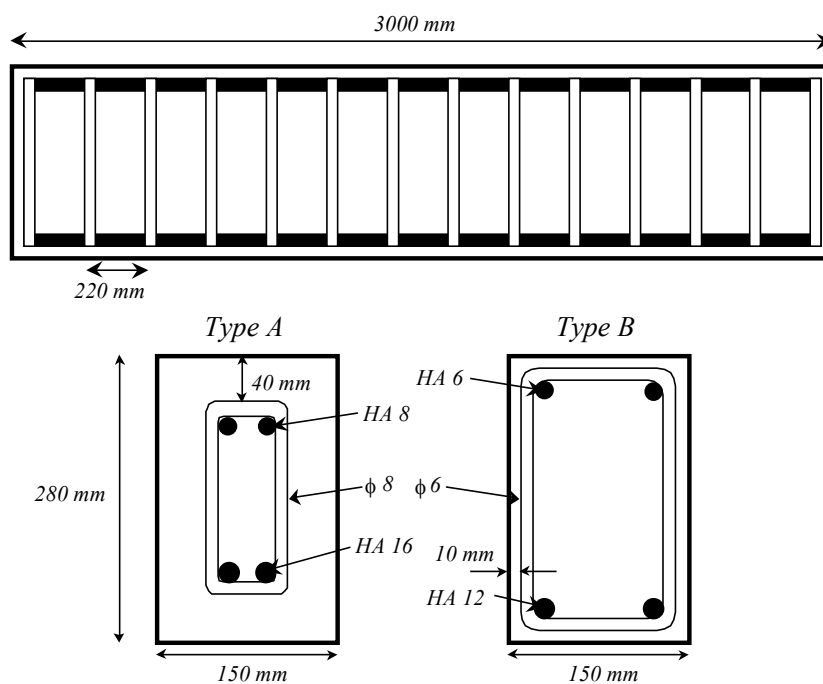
Plan de ferrailage des poutres de type A et B [FRA 94]
